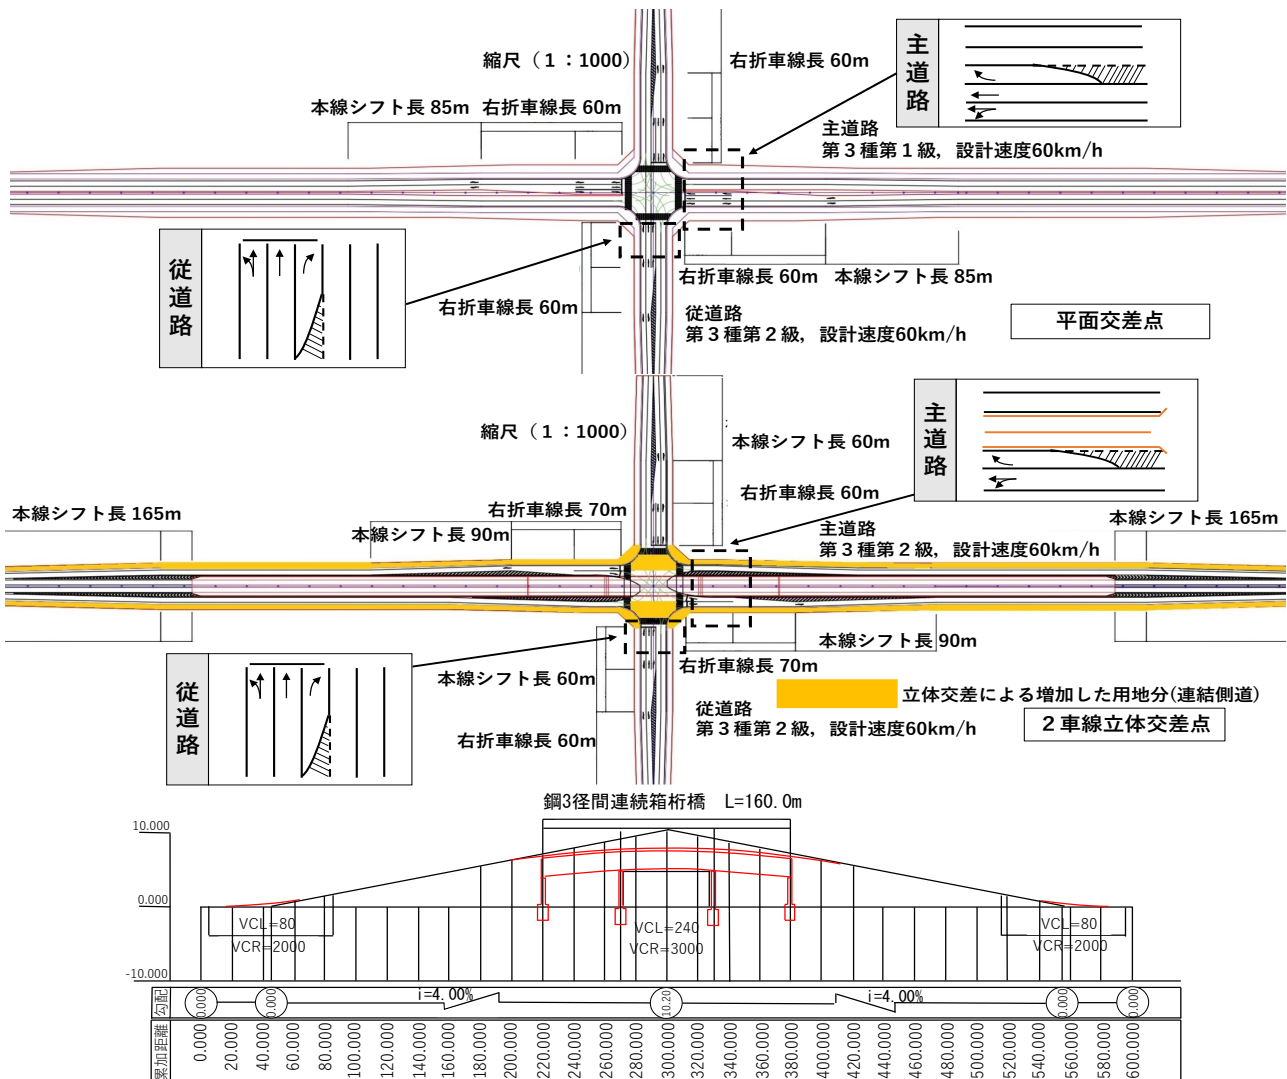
平面交差点の平面図および2車線立体交差点の平面図・縦断面図(第3種)
